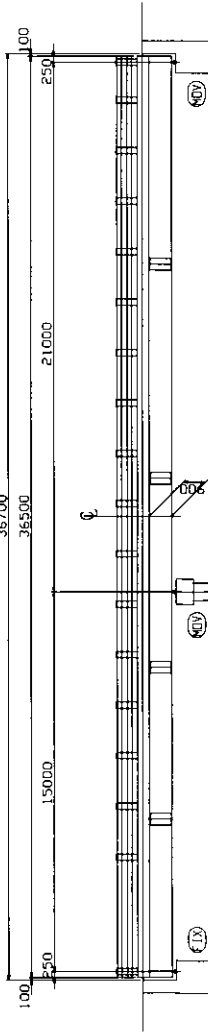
02-02-04 DALIG 桥 构造一般图
